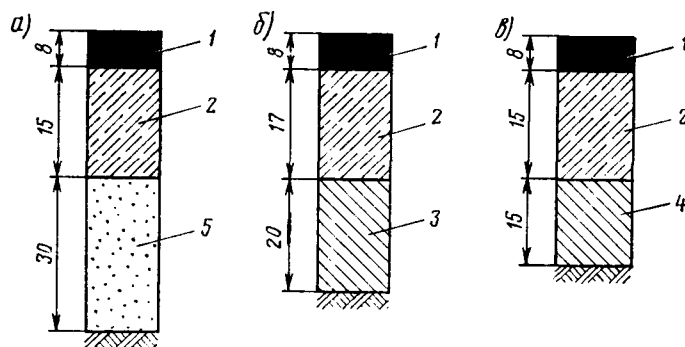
Примеры конструкций дорожных одежд с морозозащитными слоями из песка (а) и из укрепленных грунтов (б, в): 1 — асфальтобетон; 2 — грунт + 12% цемента; 3 — грунт + 4% цемента; 4 — грунт + 6% цемента; 5 — песок
